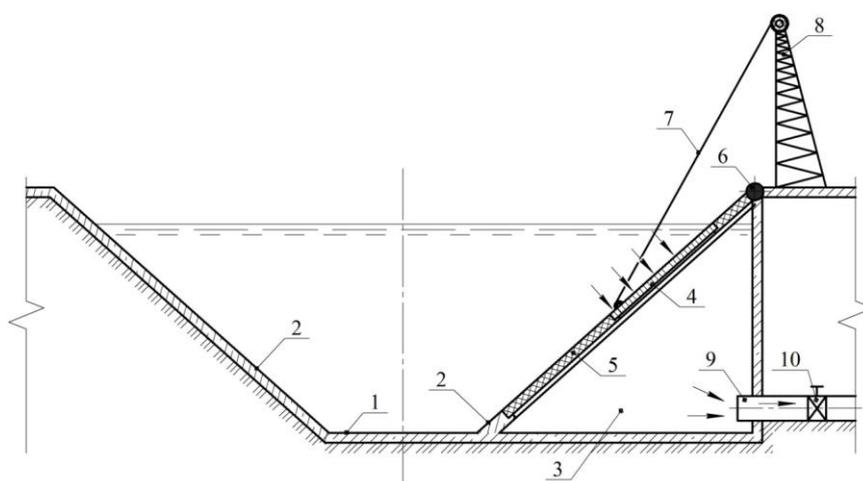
Поперечный разрез канала по оси водозаборного трубопровода с вариантом водовыпуска, забирающего воду из верхней части водного потока
